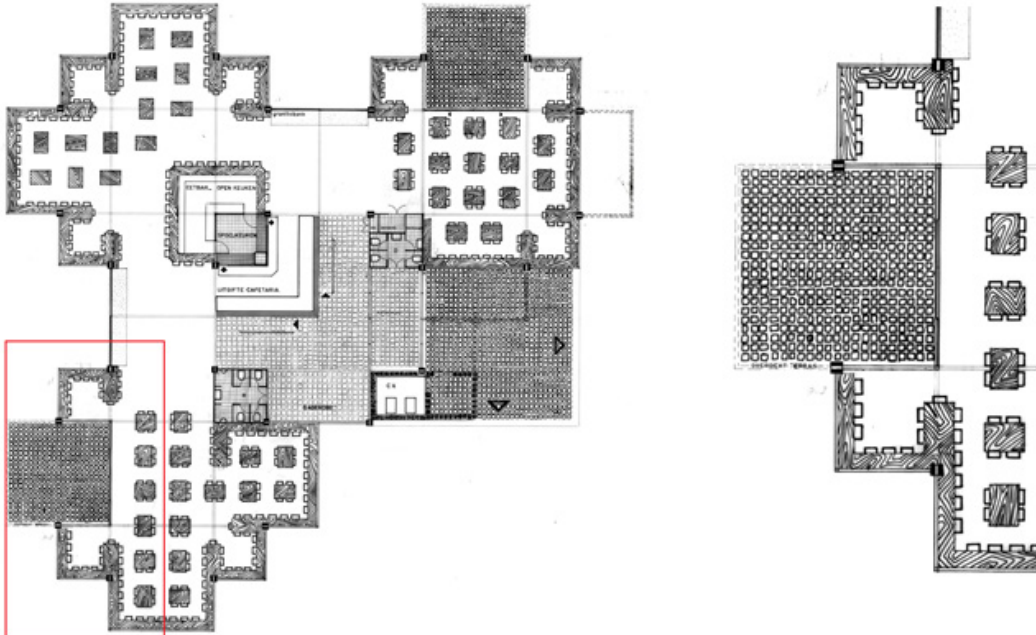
Planta general del pabellón (versión preliminar) y zoom revelando la atención mostrada al dibujo a mano de los acabados del pavimento y las texturas del mobiliario. Fuente: Collectie Het Nieuwe Instituut / STIG, 1
